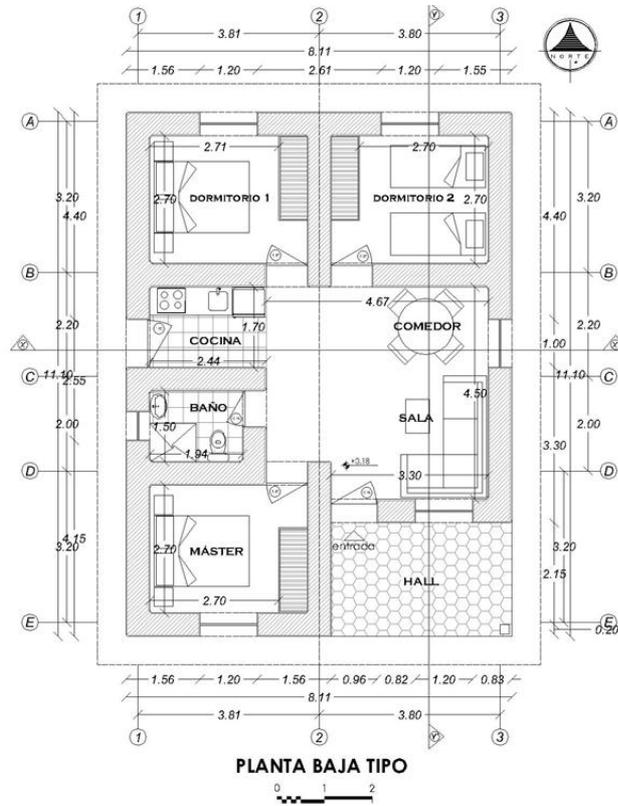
Planta Baja (Modelo con Súper Adobe).
